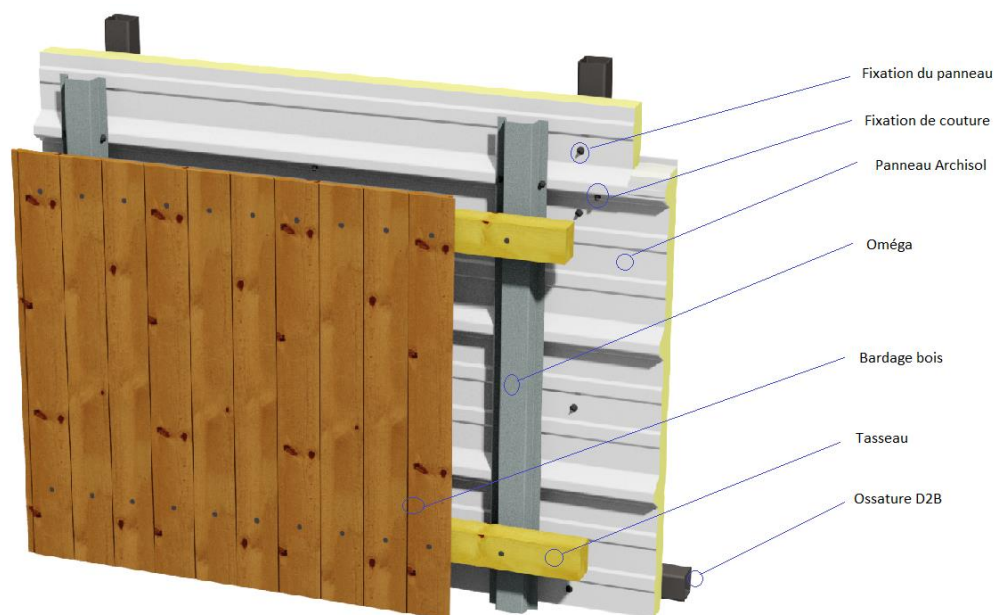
Vue 3D - Dessin de principe - panneau horizontal, double réseau d'ossature lame bois
